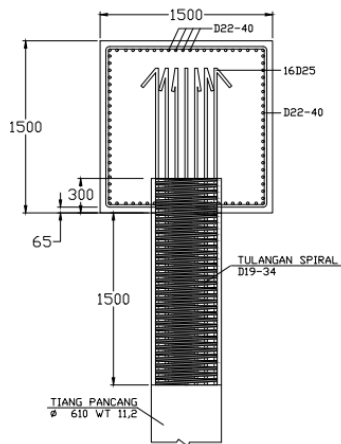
Detail Potongan Tampak Atas *Pilecap fender
